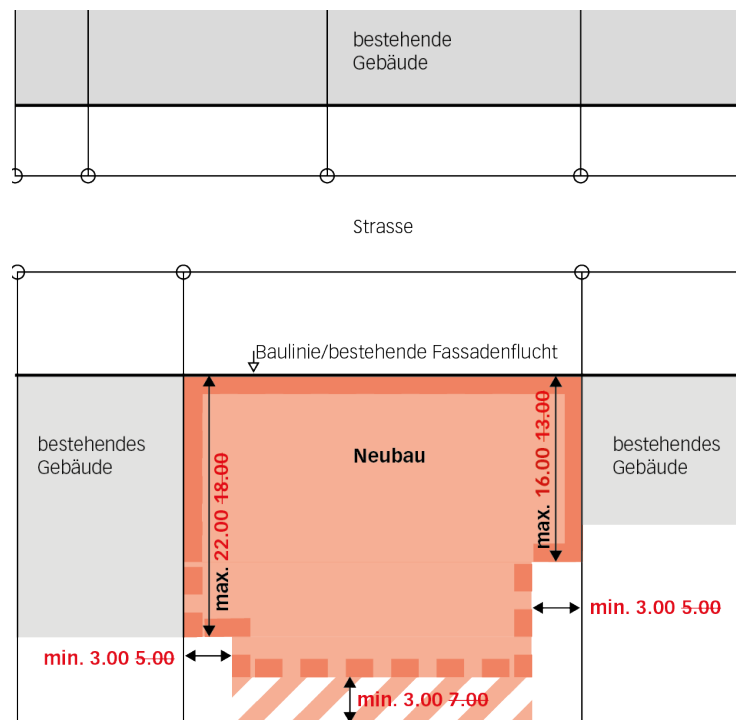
Baureglementsskizze zur geschlossenen Bauweise (rot=neu)
